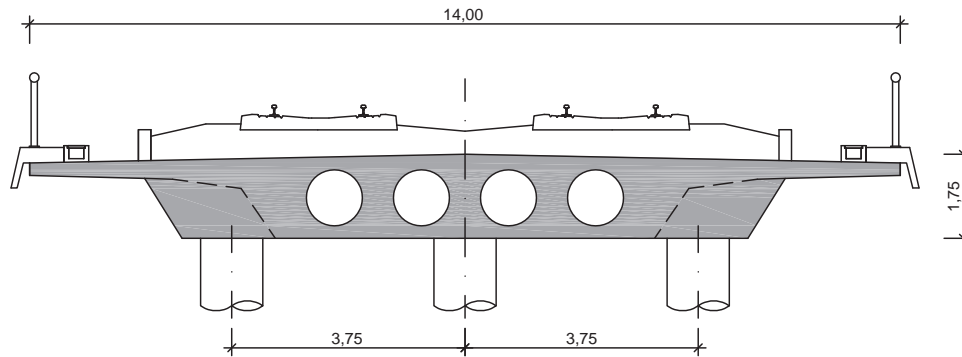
Sección sobre pilas Viaducto sobre CV-95.
